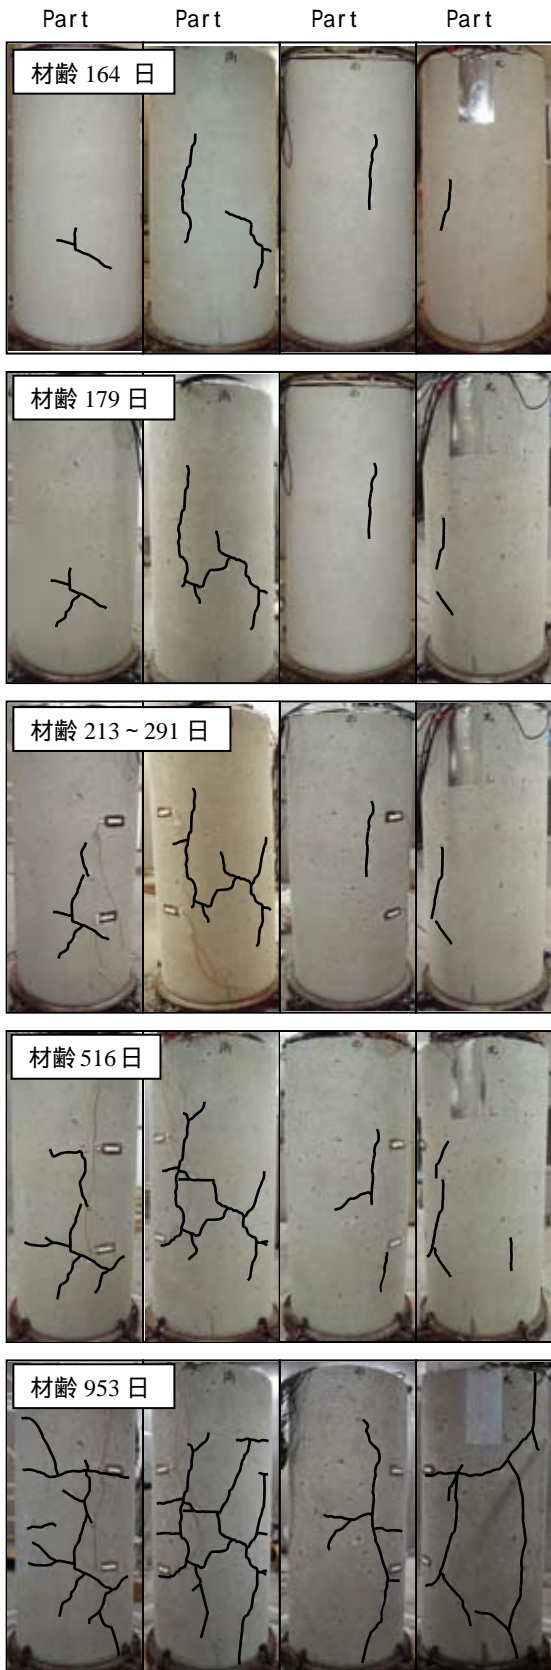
大型コンクリート円柱に発生したひび割れの進展状況
